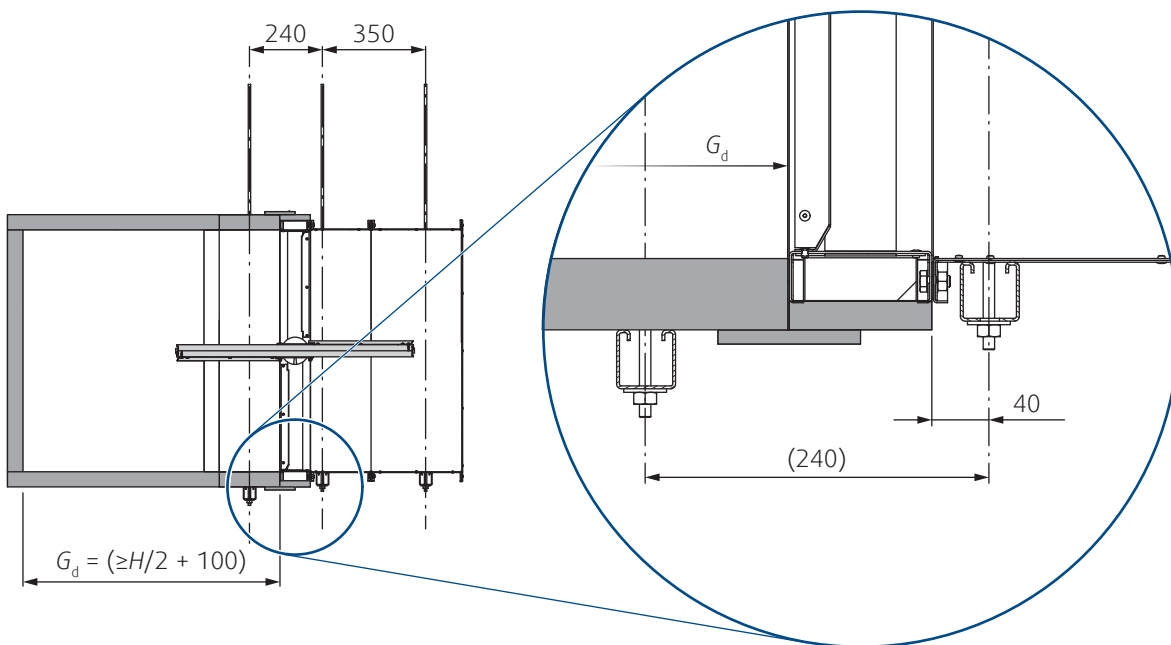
Aufhängeposition für L1H-Installation mit Detailansicht
